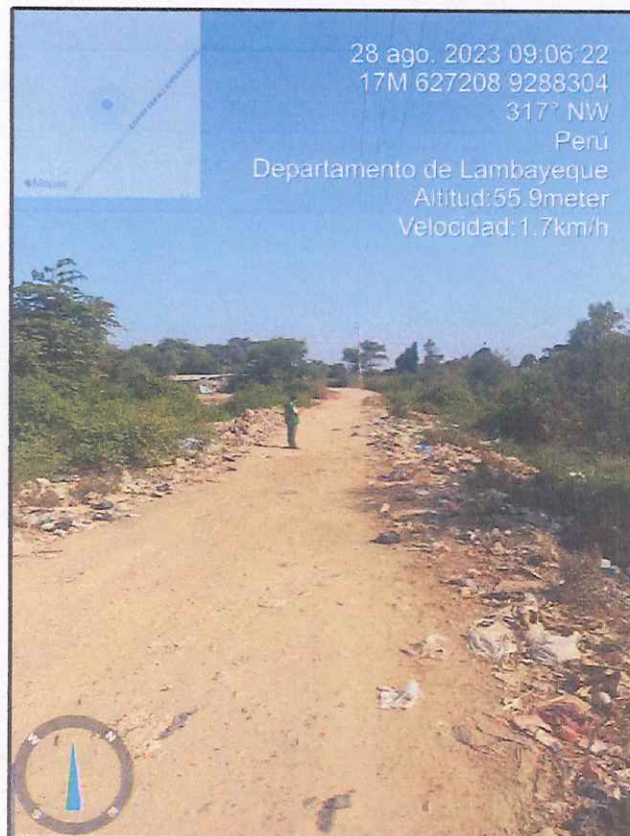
PUENTE MACHUCA – RIO MOTUPE
